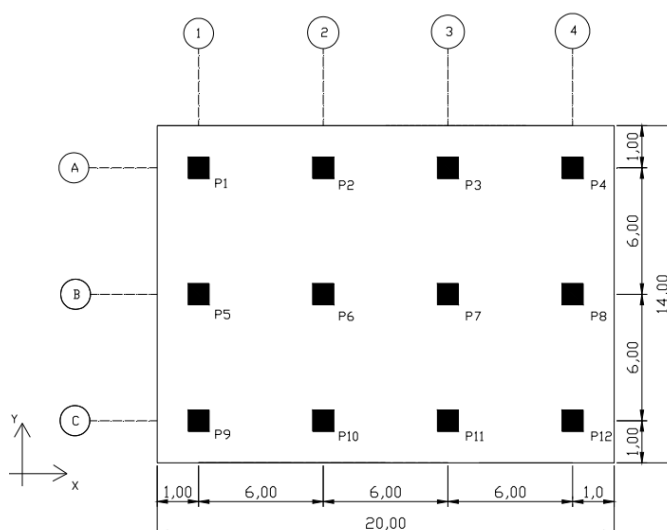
Planta baixa da estrutura – Dimensões em m (CHAVES, 2011)
